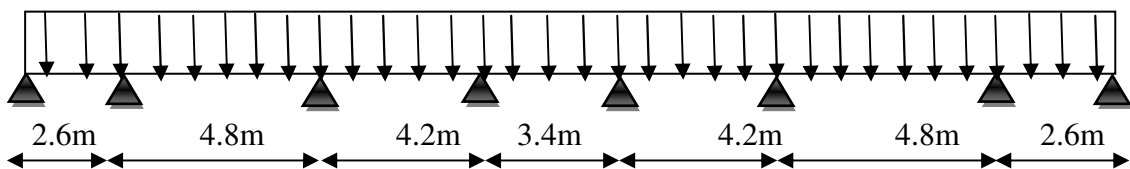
Schéma statique de la poutrelle type (02) à sept travées
